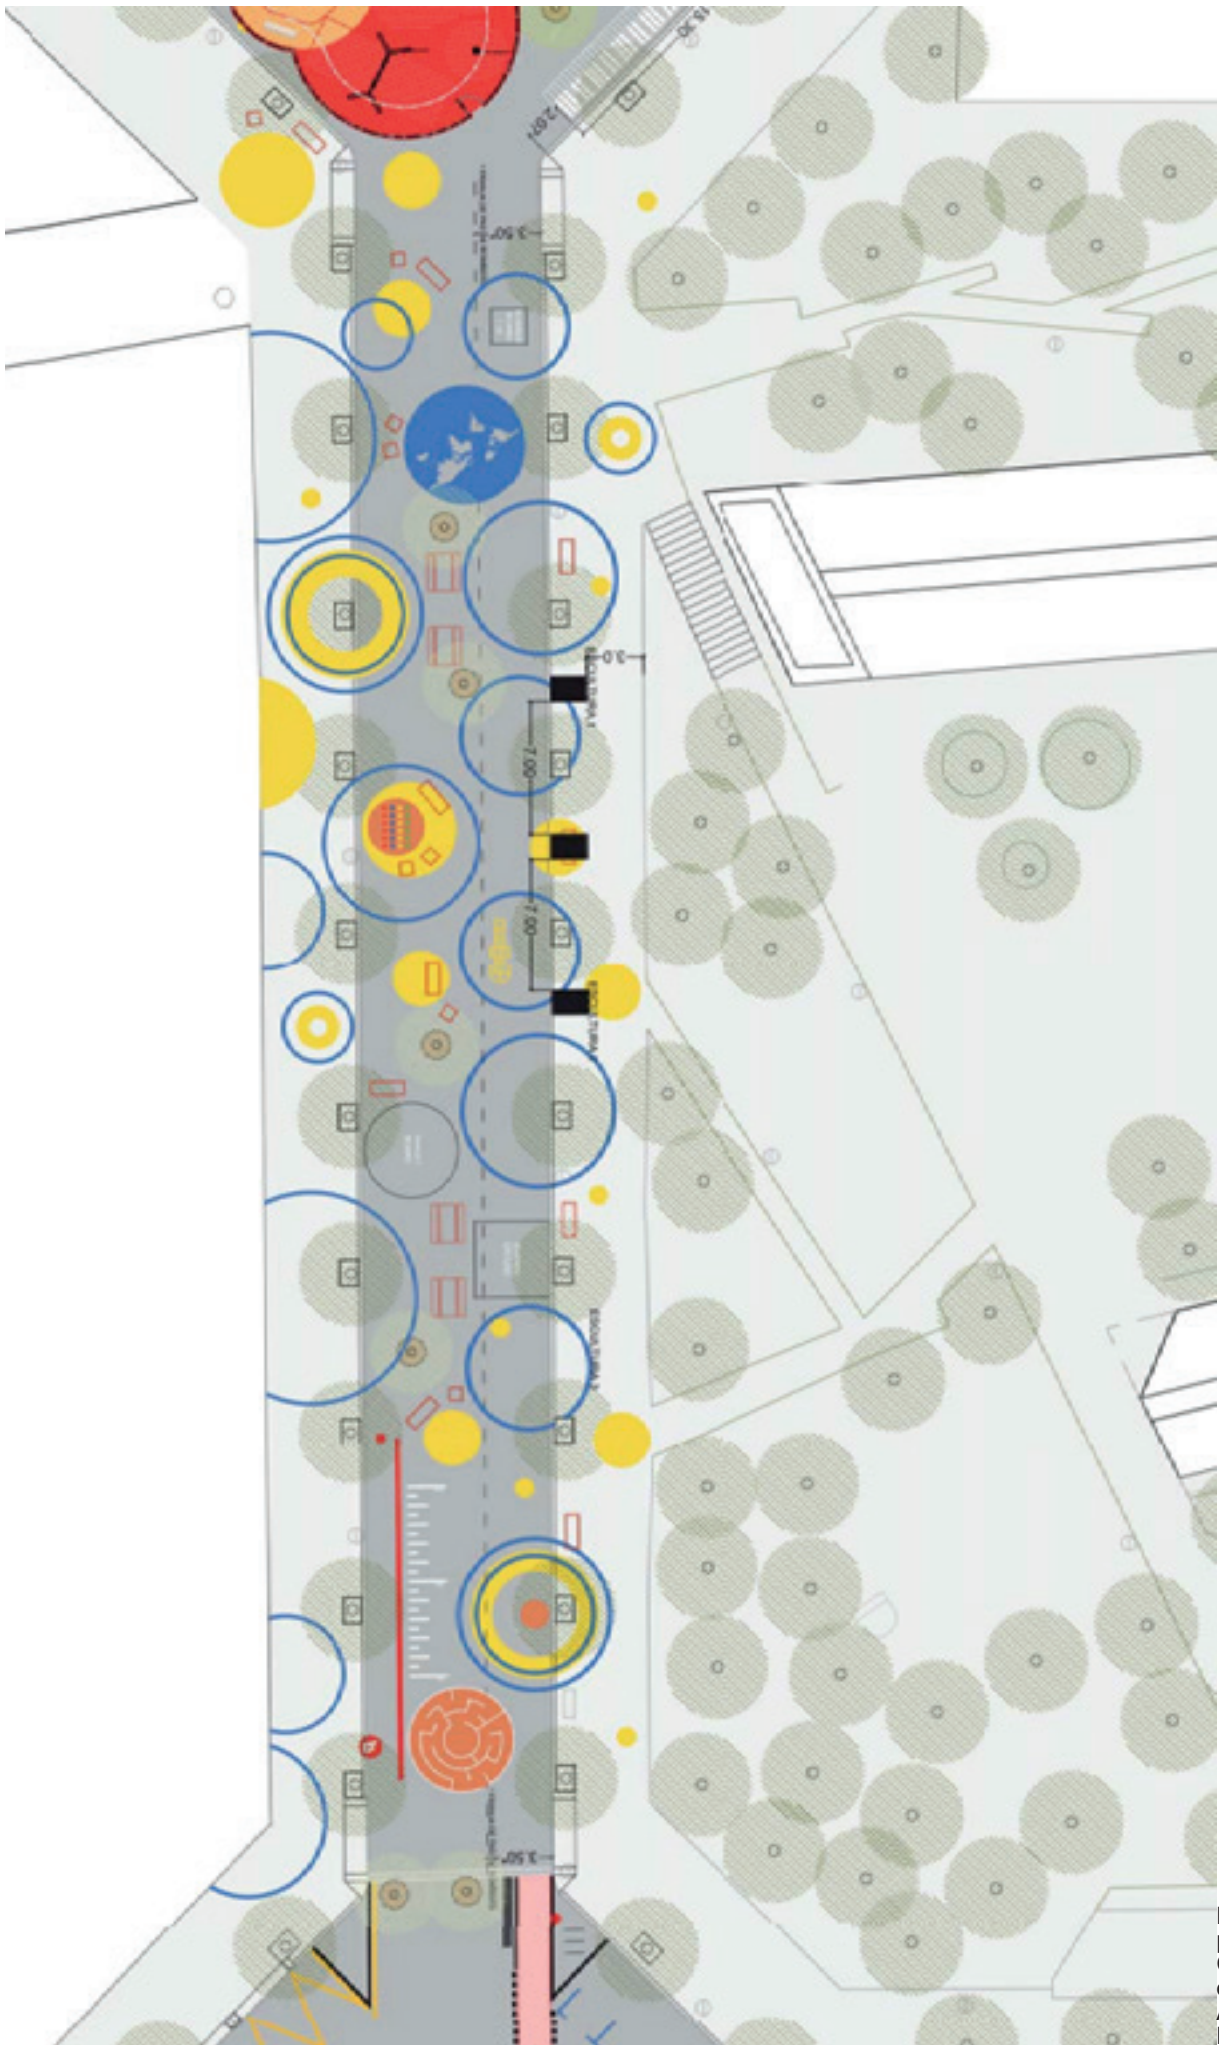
Planta proposta del Carrer Sancho d'Àvila. Font Ajuntament de Barcelona.
